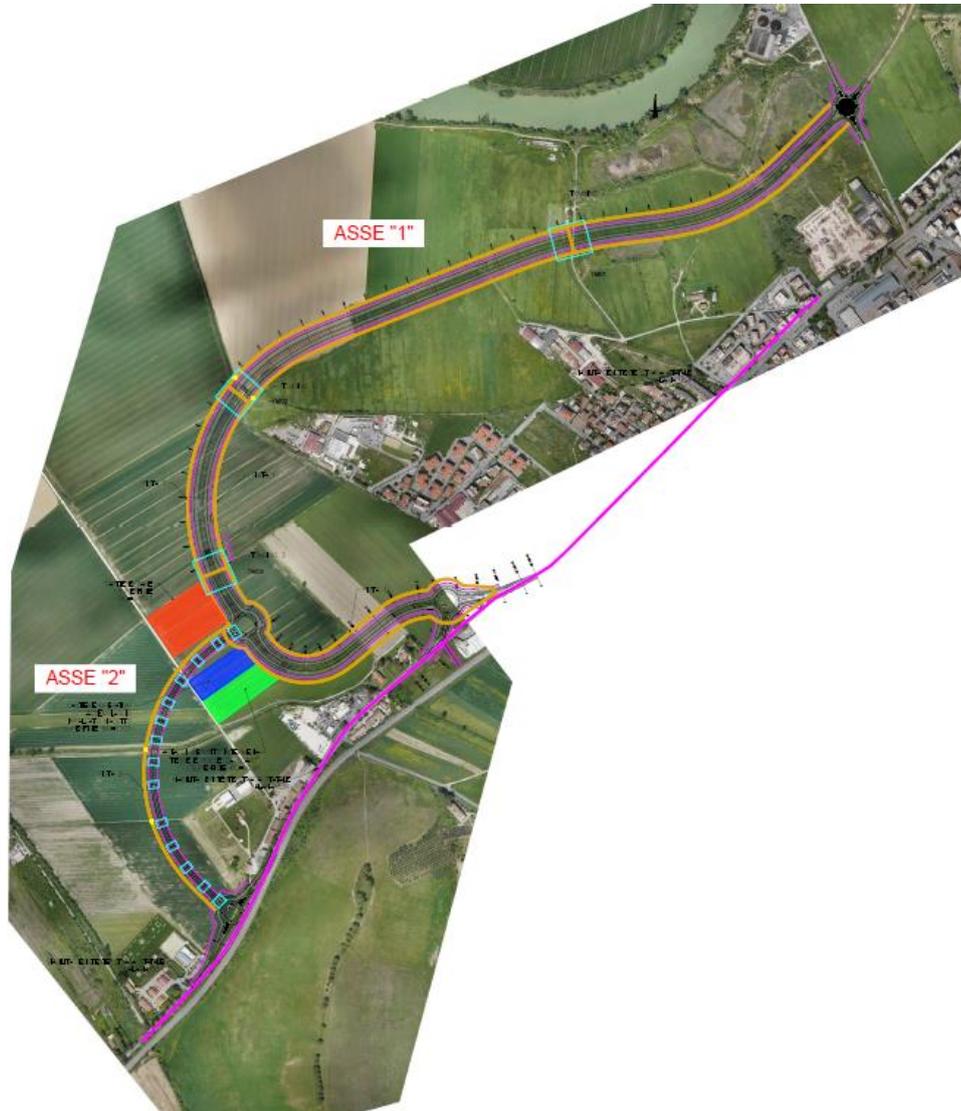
Planimetria con individuazione delle piste di cantiere (in arancione).
